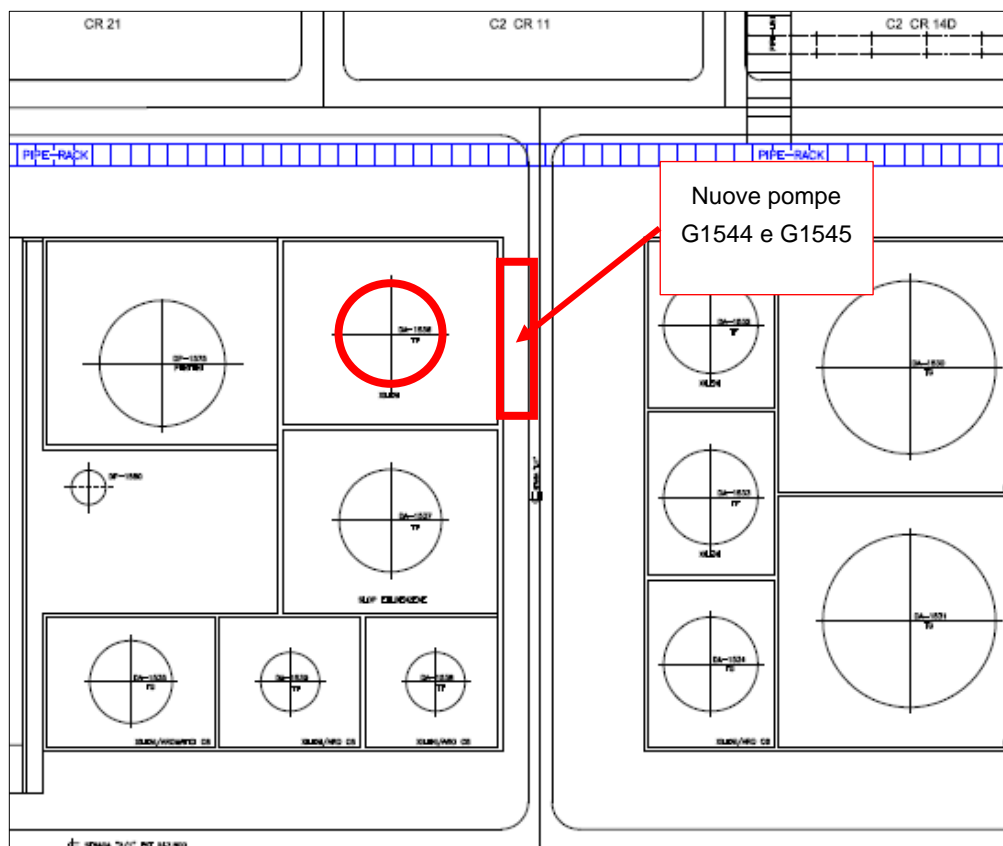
Dettaglio posizionamento planimetrico delle nuove pompe presso scarico parziale P2-3Figura 19: Dettaglio posizionamento planimetrico serbatoio DA1536*Interventi in area SG11 (P2-22, P2-23)
